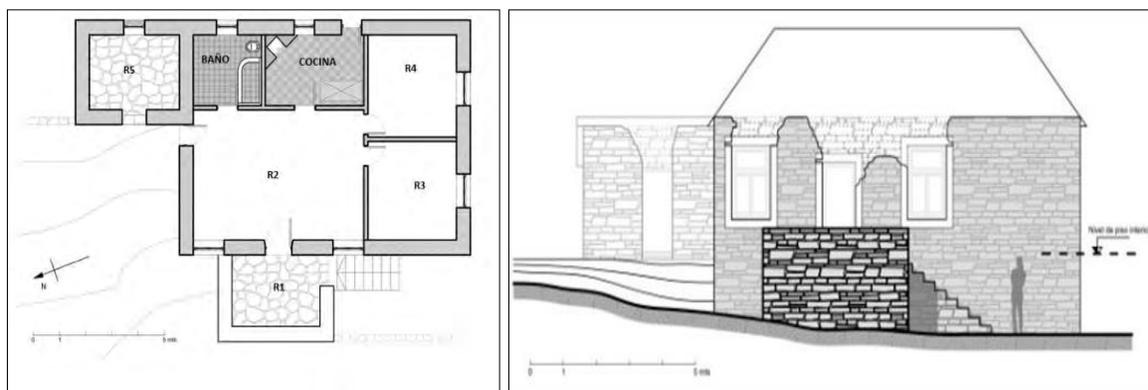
Plano de la Estructura I donde se destaca la ubicación de cada recinto (izquierda); Reconstrucción hipotética de la fachada (derecha). Tomado y modificado de Schávelzon e Igareta (2017a:102).
